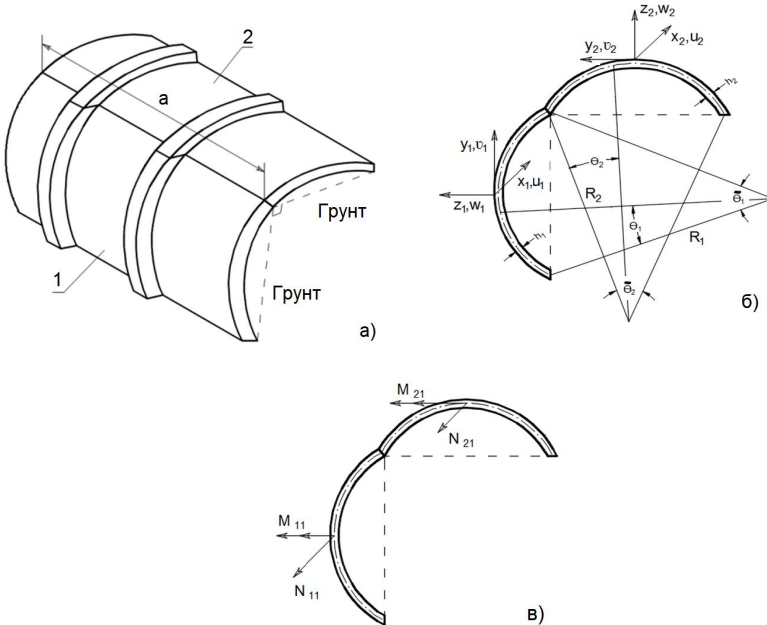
Схема усиленной подпорной стенки, выполненной из соединения ортотропных цилиндрических оболочек
